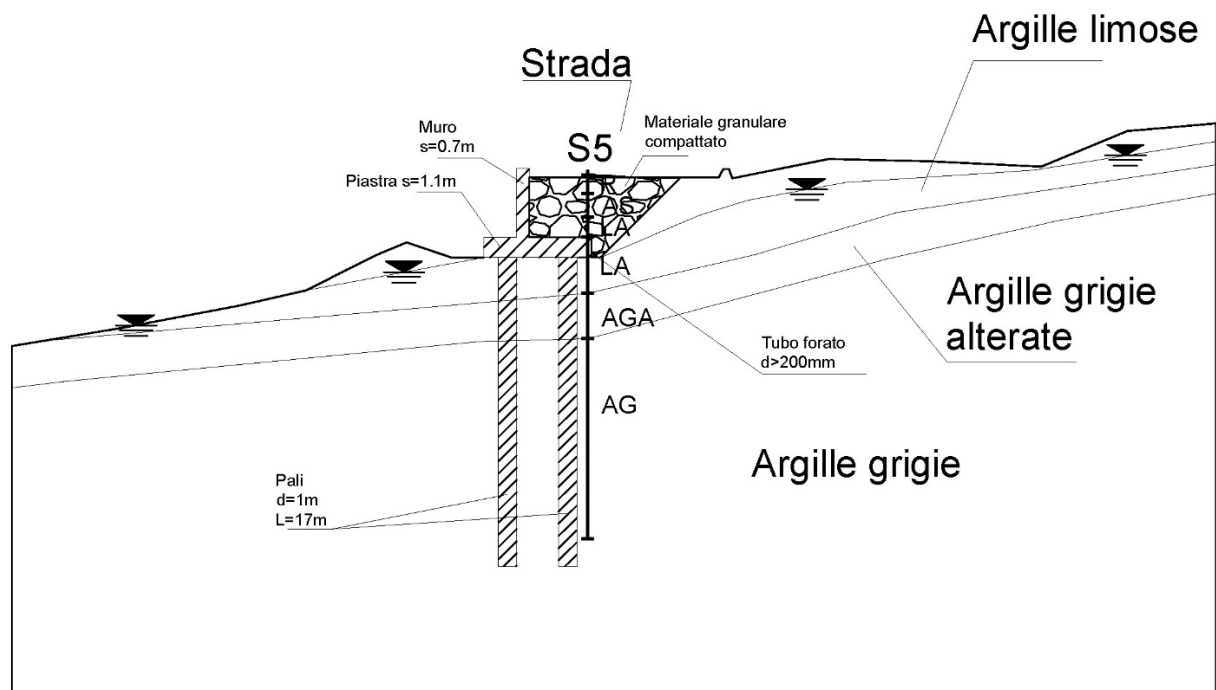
Dissesto al km 9+800. Sezione con schema degli interventi di consolidamento. Sulla parete verticale del muro saranno predisposti fori drenanti.
